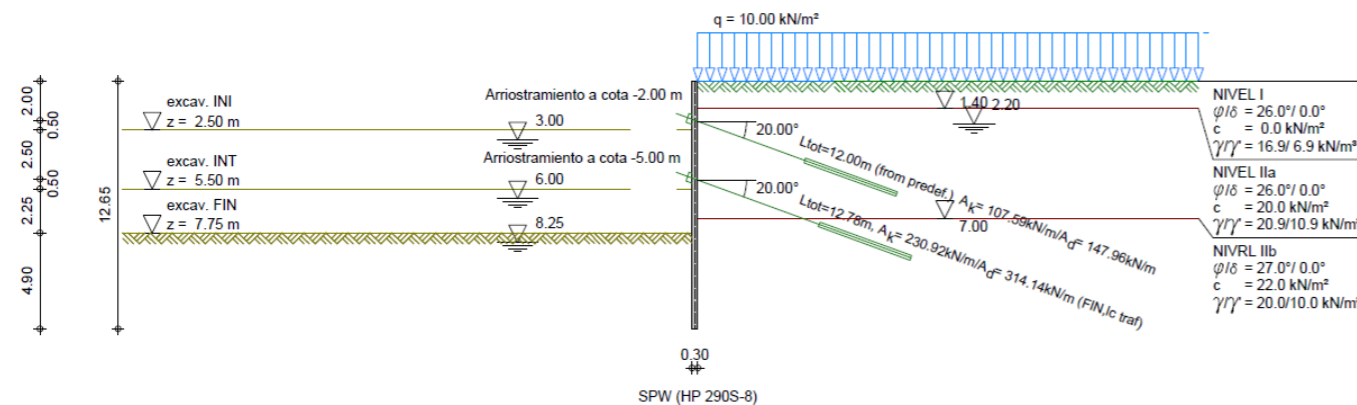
Tablestaca con dos niveles de anclaje. Fuente: Elaboración propia
